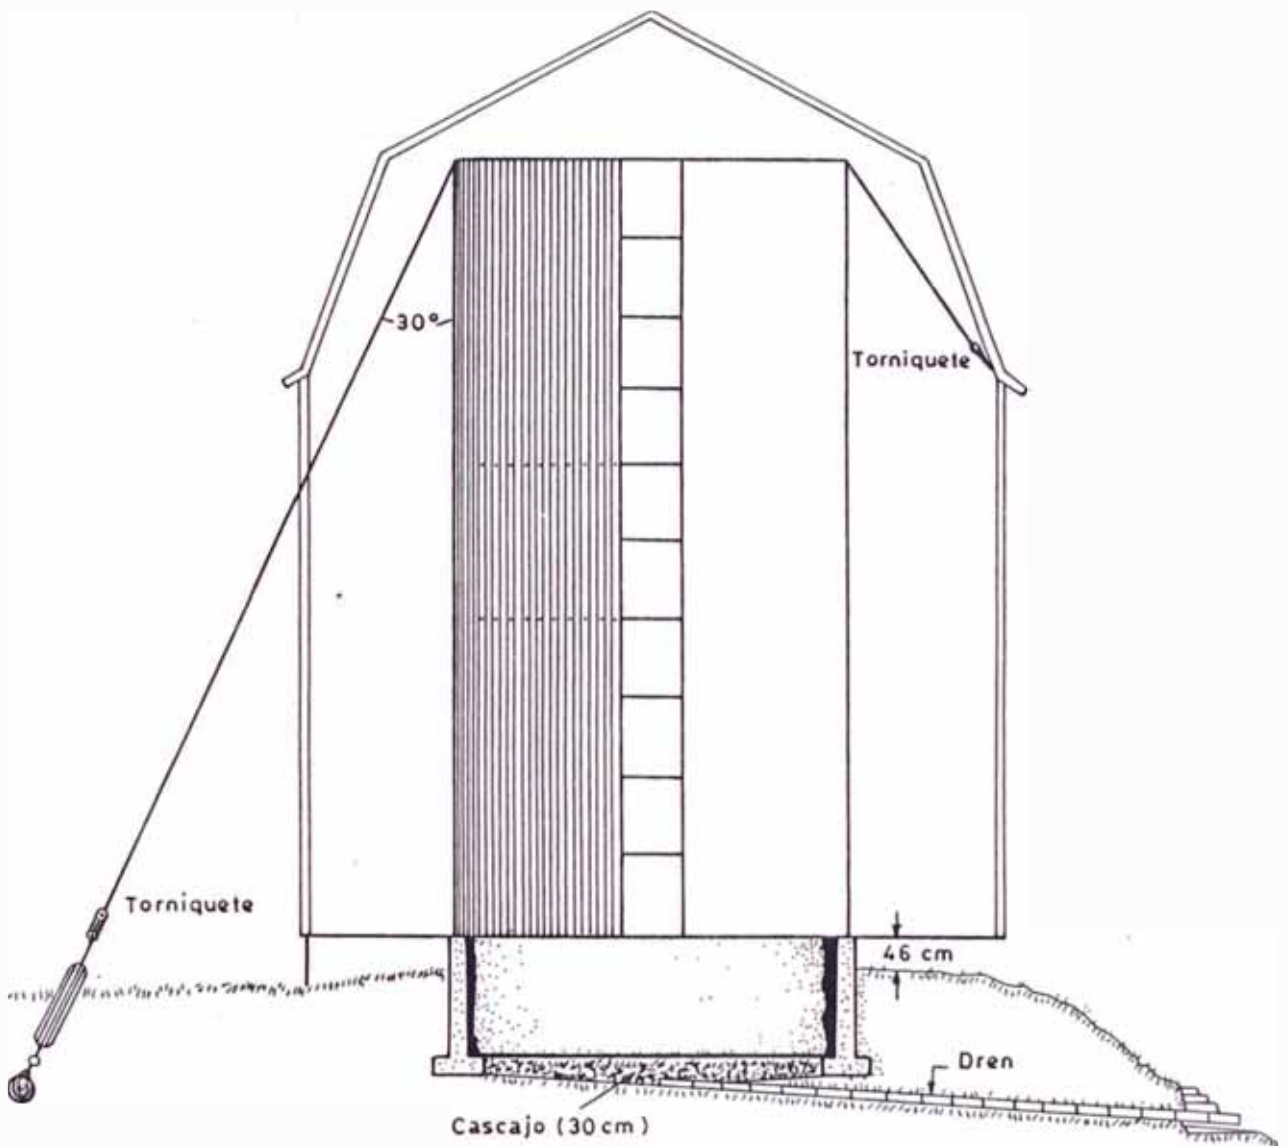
DETALLES DE CONSTRUCCION PARA LA INSTALACION DE UN SILO DE DUELAS DE MADERA
